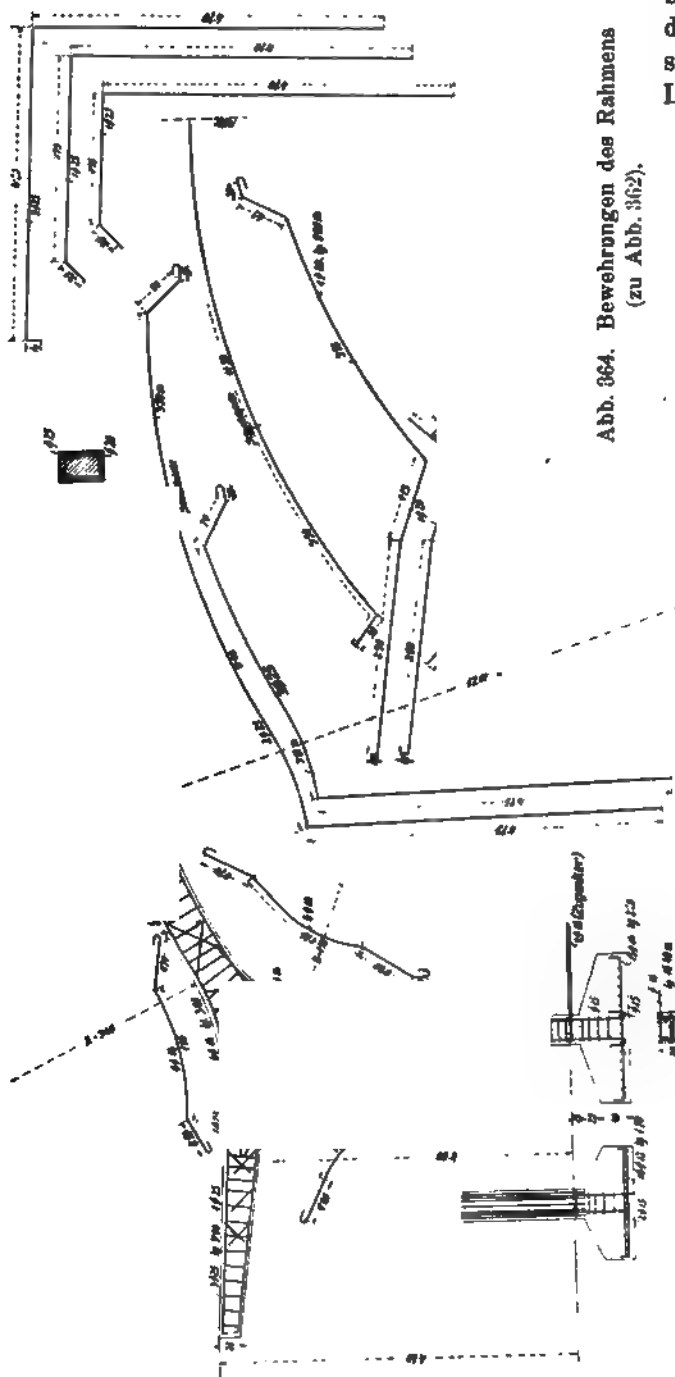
Bewehrungen des Rahmens (zu Abb. 362).
